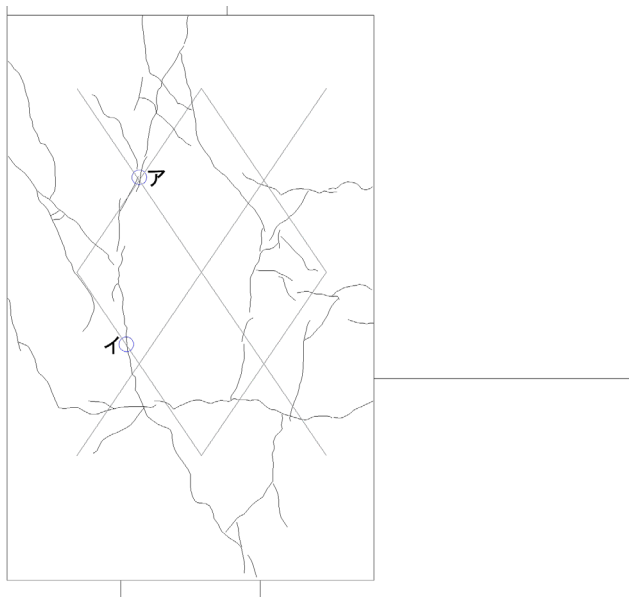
3. 230 パイルキャップひび割れ幅測定位置 (試験体 C-1 正載荷)
